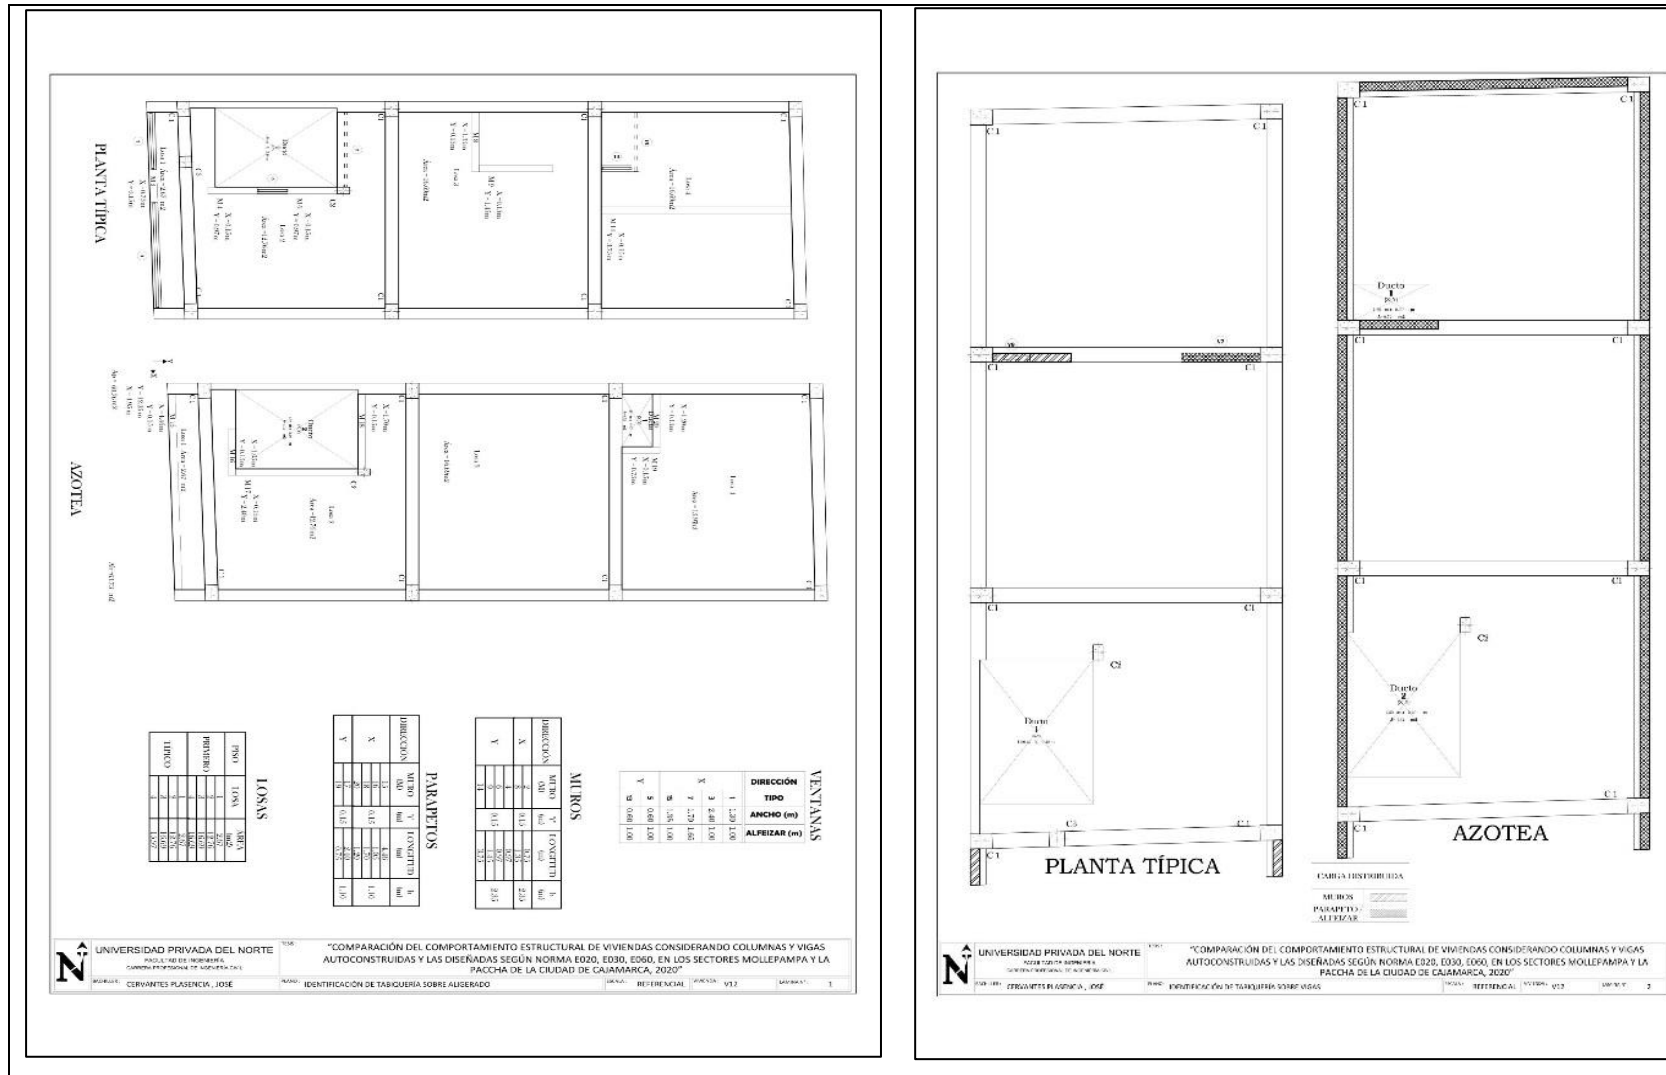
Tabiquería sobre losa aligerada y vigas vivienda 12
